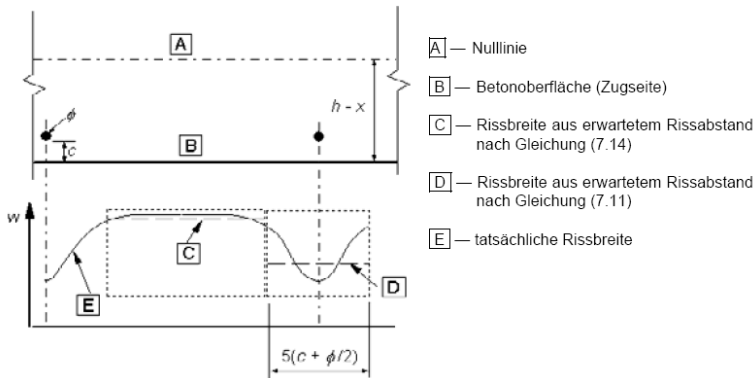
Rissbreite w an der Betonoberfläche in Bezug auf den Stababstand
